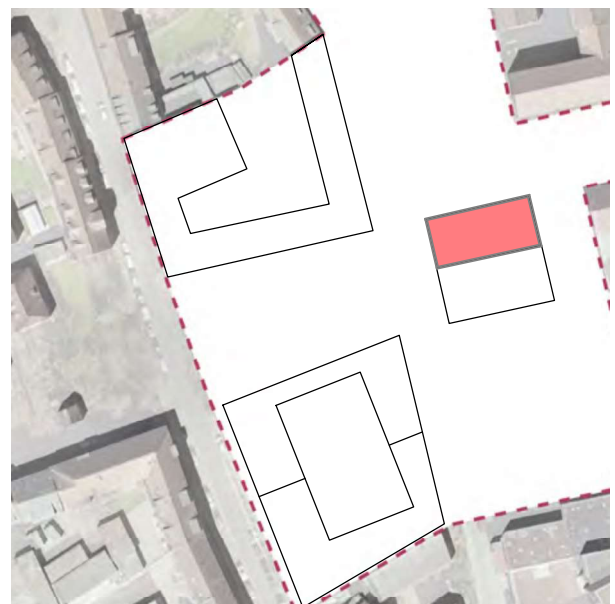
Grundriss OG5 Großer Hof V2
